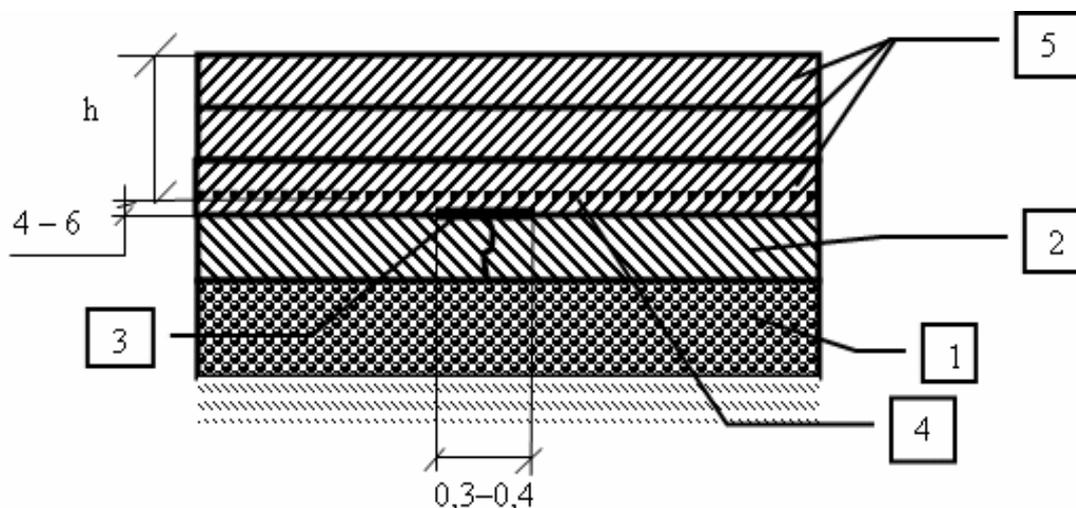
Конструкция армирования асфальтобетонного покрытия на жестком основании:
